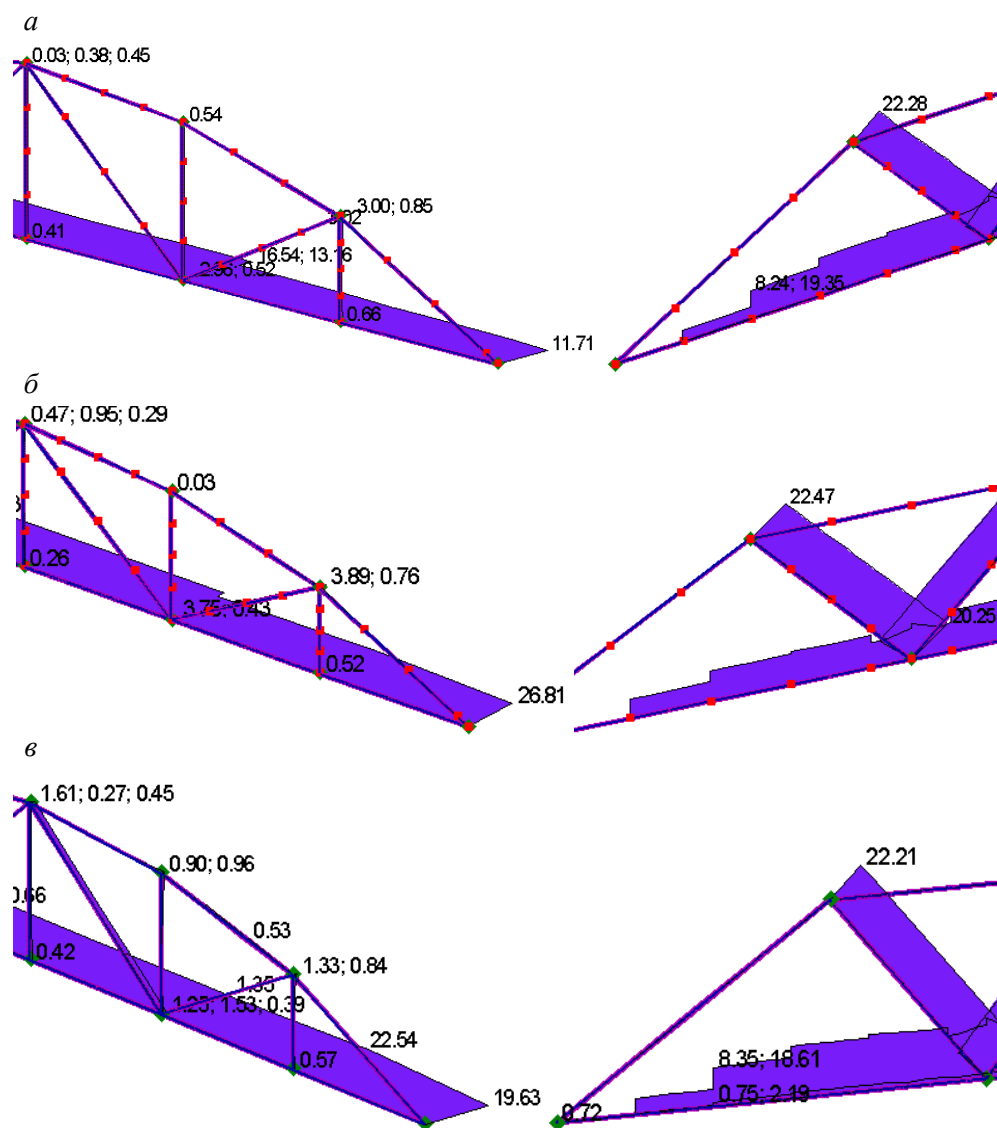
Эпюры необходимого расчетного продольного армирования (см<sup>2</sup>) в рядовых стропильной и подстропильной фермах:
